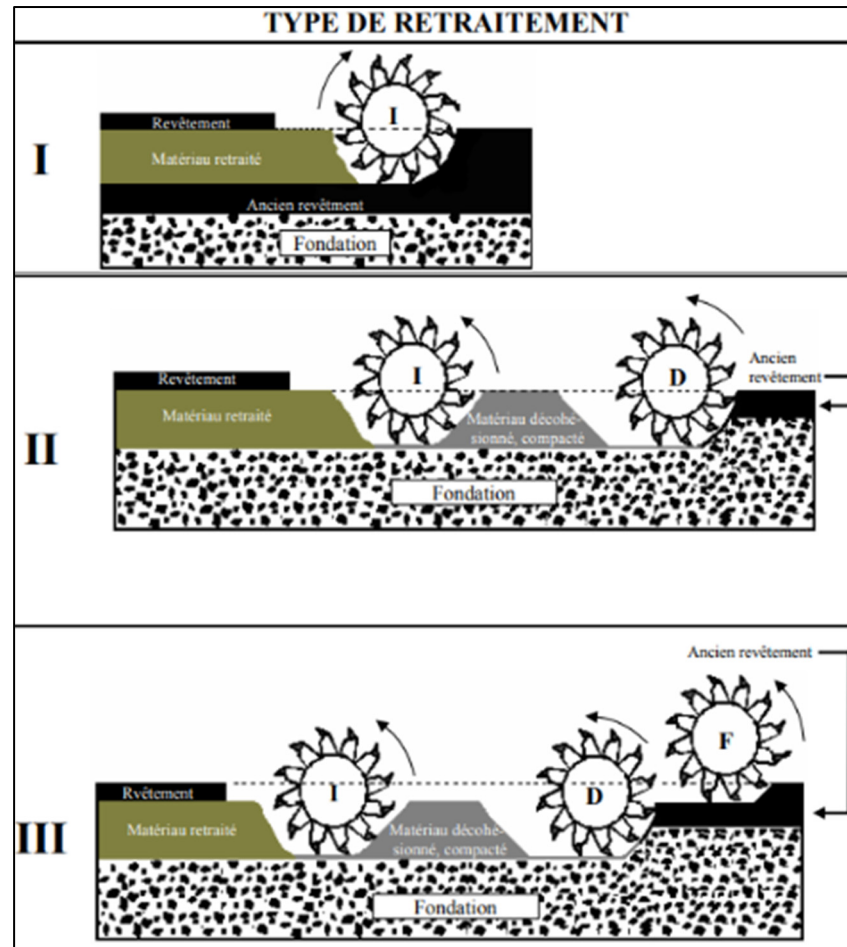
Charte #2 - Le retraitement à froid des chaussées souples
